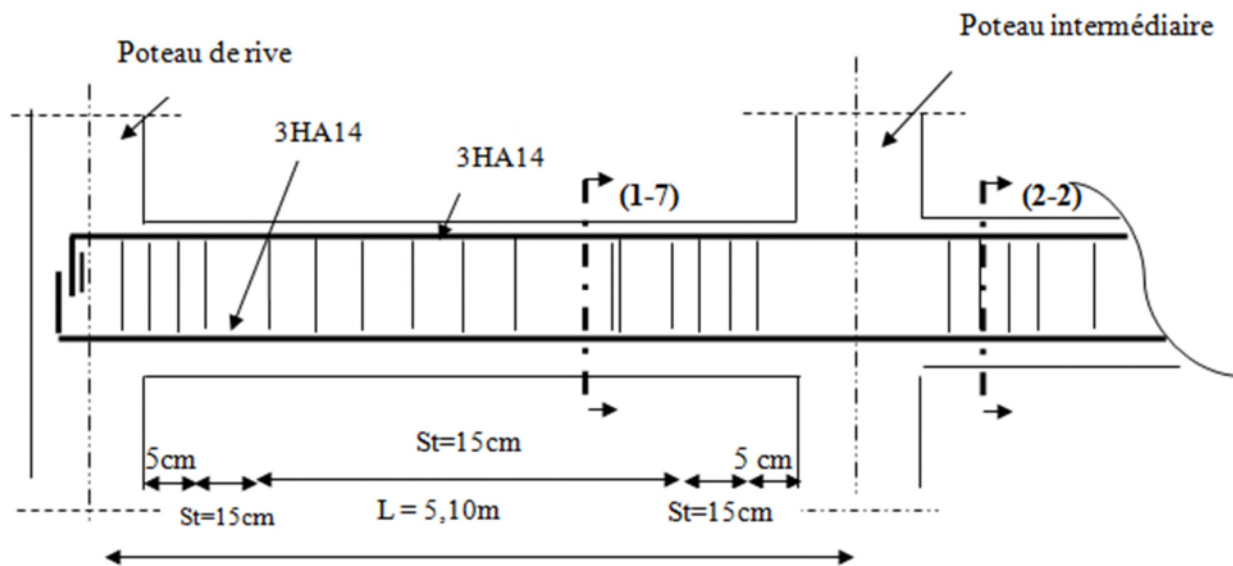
Schéma de ferrailage de la poutre principale (30*45) et (30*40) et poutre secondaire (30*40) de la Terrasse inaccessible
